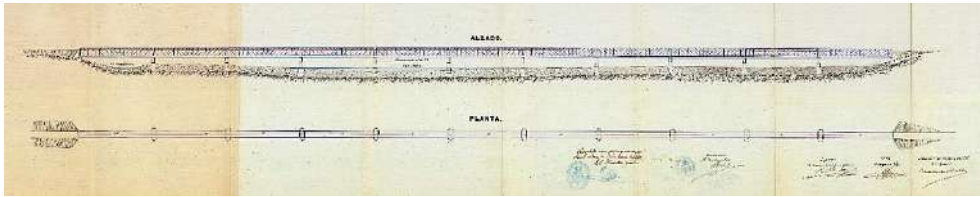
Alzado y planta del puente, tipo Linville, sobre el río Guadiana (1882). Colección autor.
